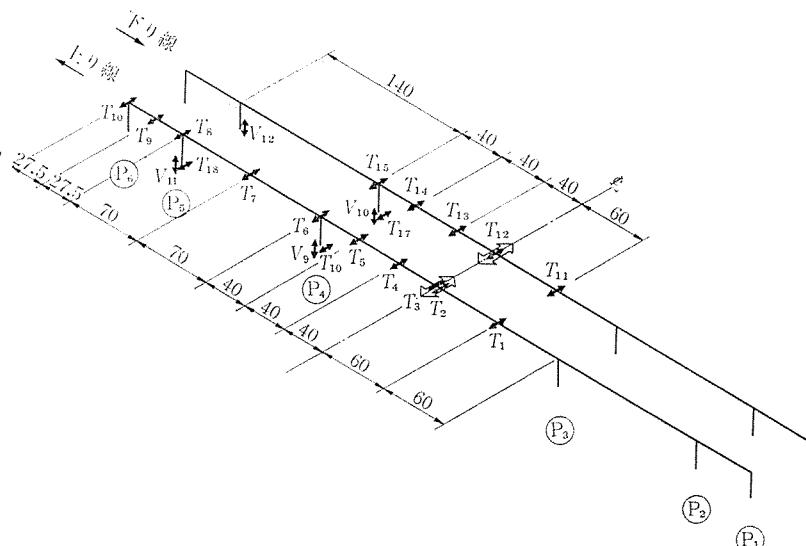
中央ヒンジ部・橋軸直角水平方向加振時の測定位置
